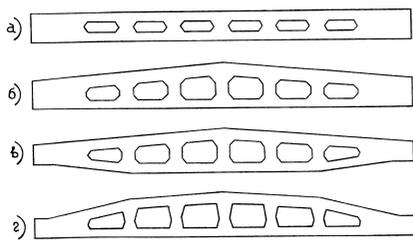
Типы решетчатых балок: а) с параллельными поясами, б) двускатные, в) двускатные с отогнутой арматурой, г) арочные
